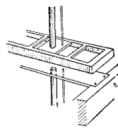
Крепление модели трубопроводов в массиве плит междуэтажного перекрытия
